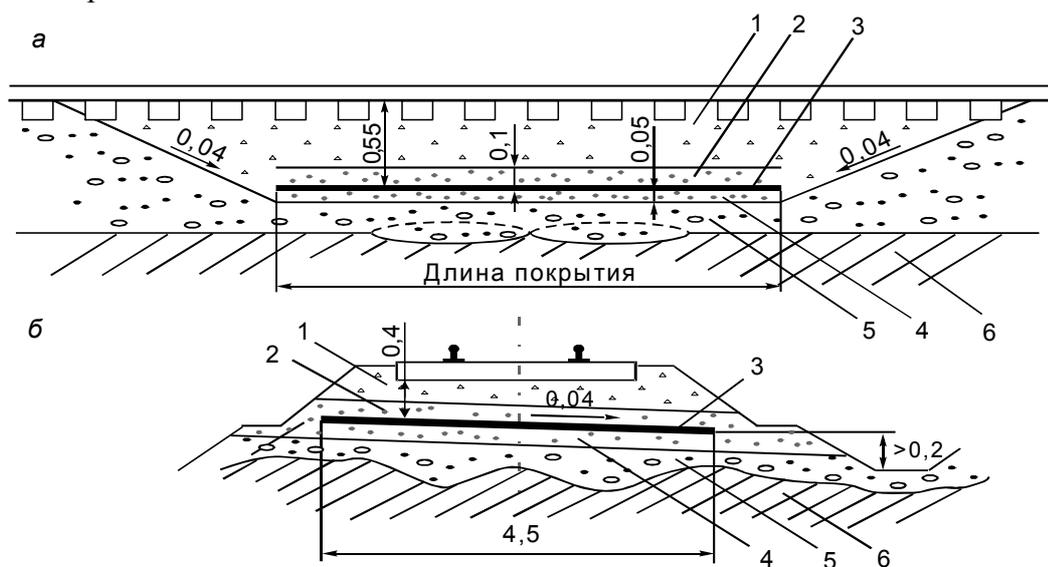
Схема устройства гидроизоляционного покрытия в пределах основной площадки: а – продольный разрез; б – поперечный разрез; 1 – балластная призма; 2 – верхний защитный слой; 3 – слой гидроизоляции; 4 – нижний защитный слой; 5 – слой старого балласта; 6 – связные грунты
